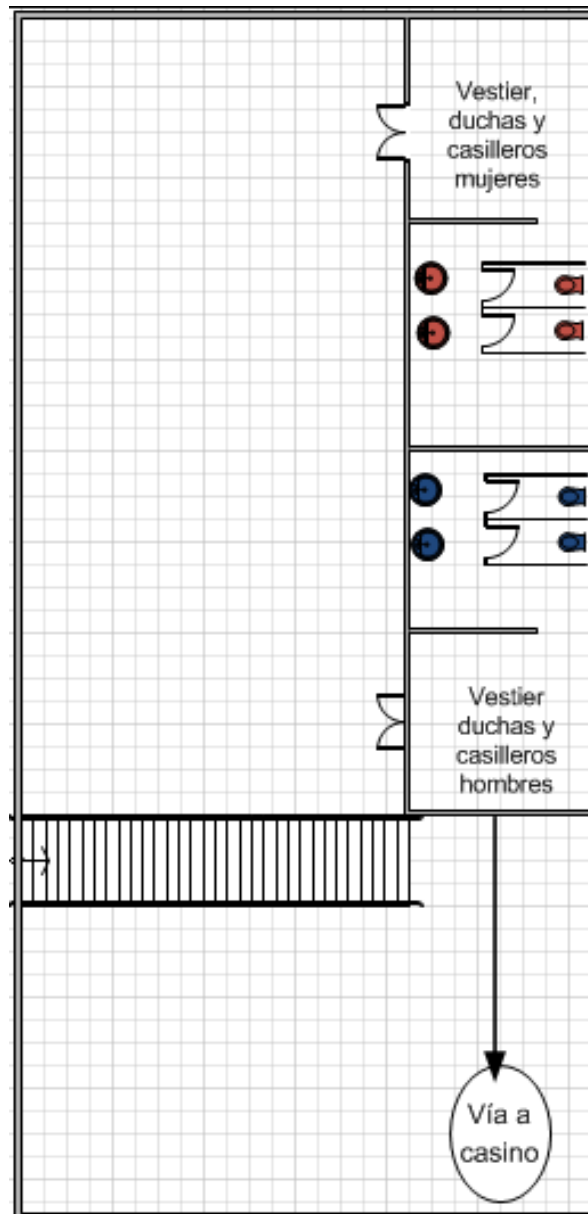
, Plano actual de la Plataforma Logística Los Luceros, planta segundo piso. Fuente el Autor.
